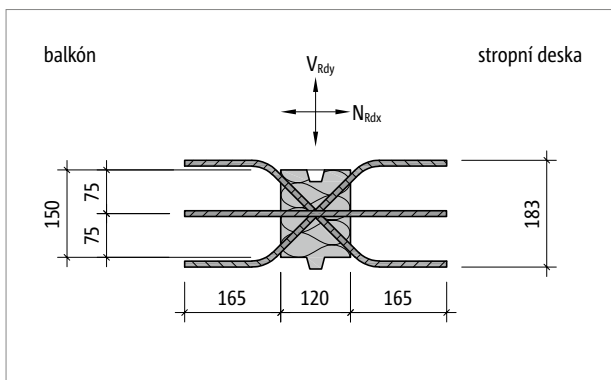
Schöck Isokorb® XT typ HP-NN2: Řez prvkem
